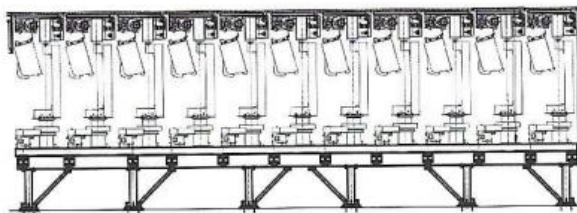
Vue en coupe des gradins du parterre en configuration debout (parterre escamoté)
